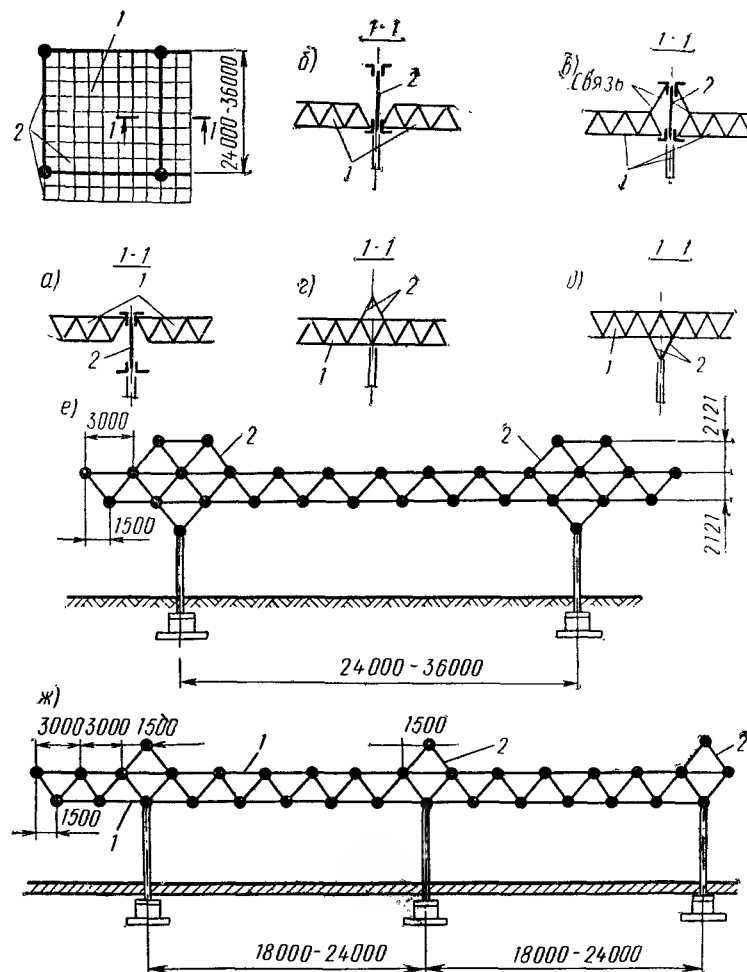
Варианты опирания (а—ж) перекрестно-стержневой пространственной конструкции (1) на подстропильные фермы (2)
